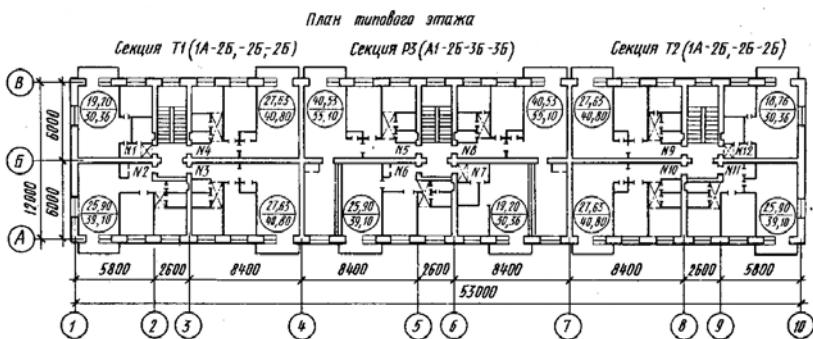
План типового этажа пятиэтажного жилого дома
